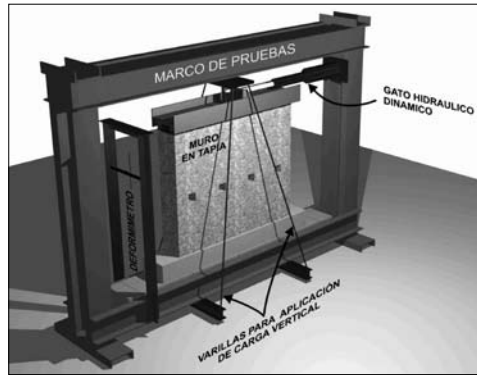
Esquema del montaje para ensayos de muros con carga paralela al plano.
